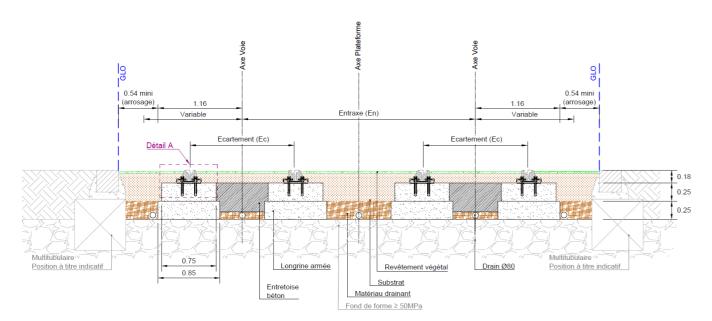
coupe type d'une plateforme pour voie sur longrines - Revêtement végétal
